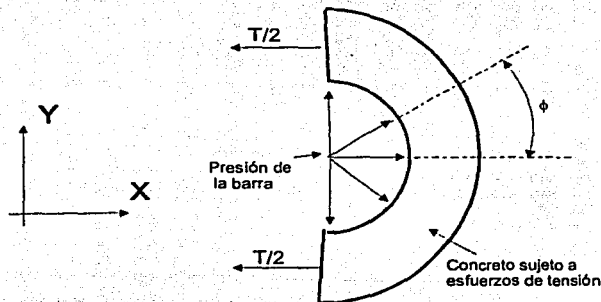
Esfuerzos de tensión en el concreto por el fenómeno de separación
